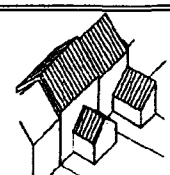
bâtiment secondaire adossé au mur gouttereau
